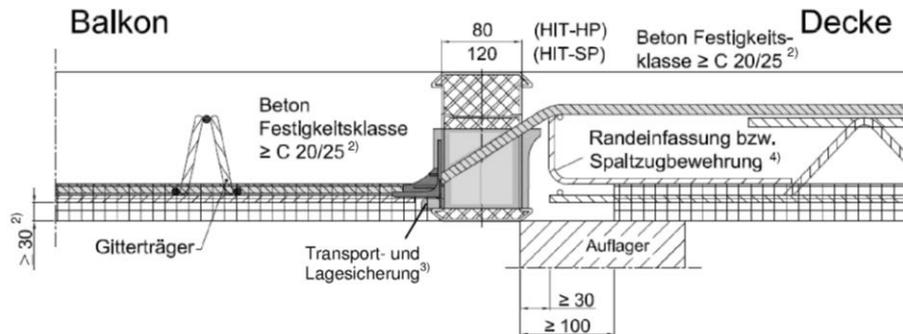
Beispiel für den Anschluss HIT-HP/SP ZV an Elementplatten mit statisch - wirksamer Ortbetonschicht
